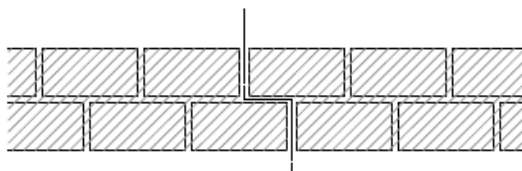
Junta de movimiento con solape. Esquema en planta
